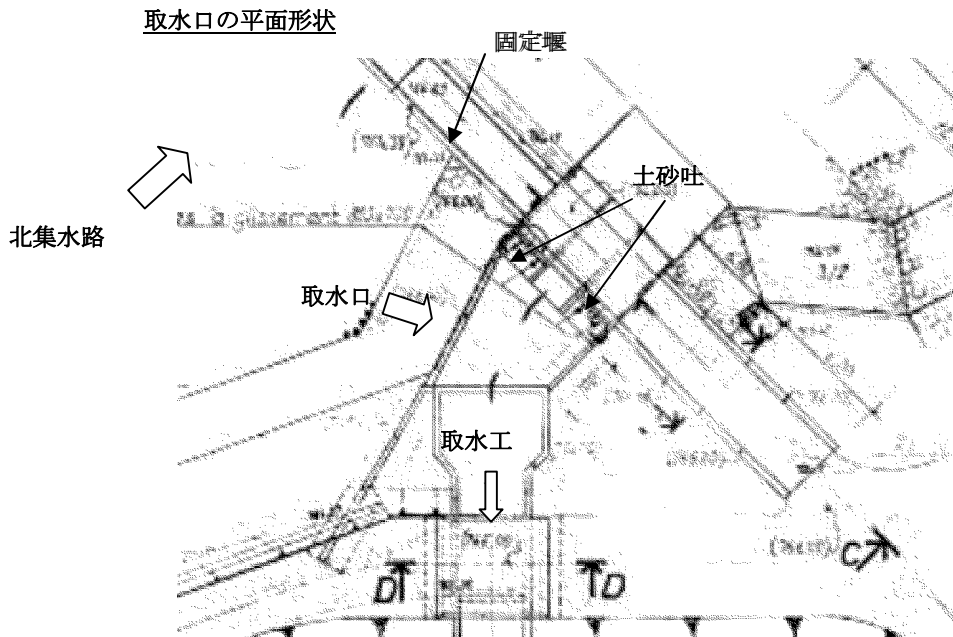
既設アンドラノチミオチャ頭首工平面図
